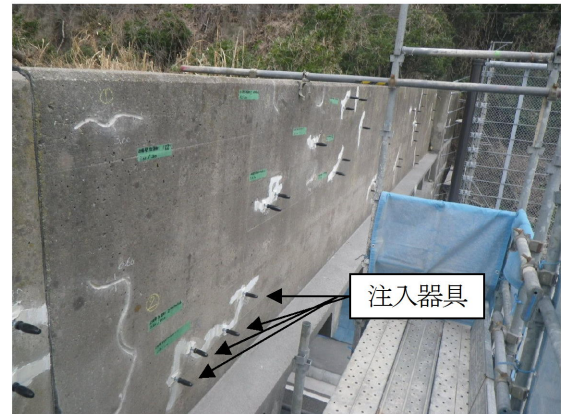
午房ヶ平一ロックシェッド状況 (施工前)
